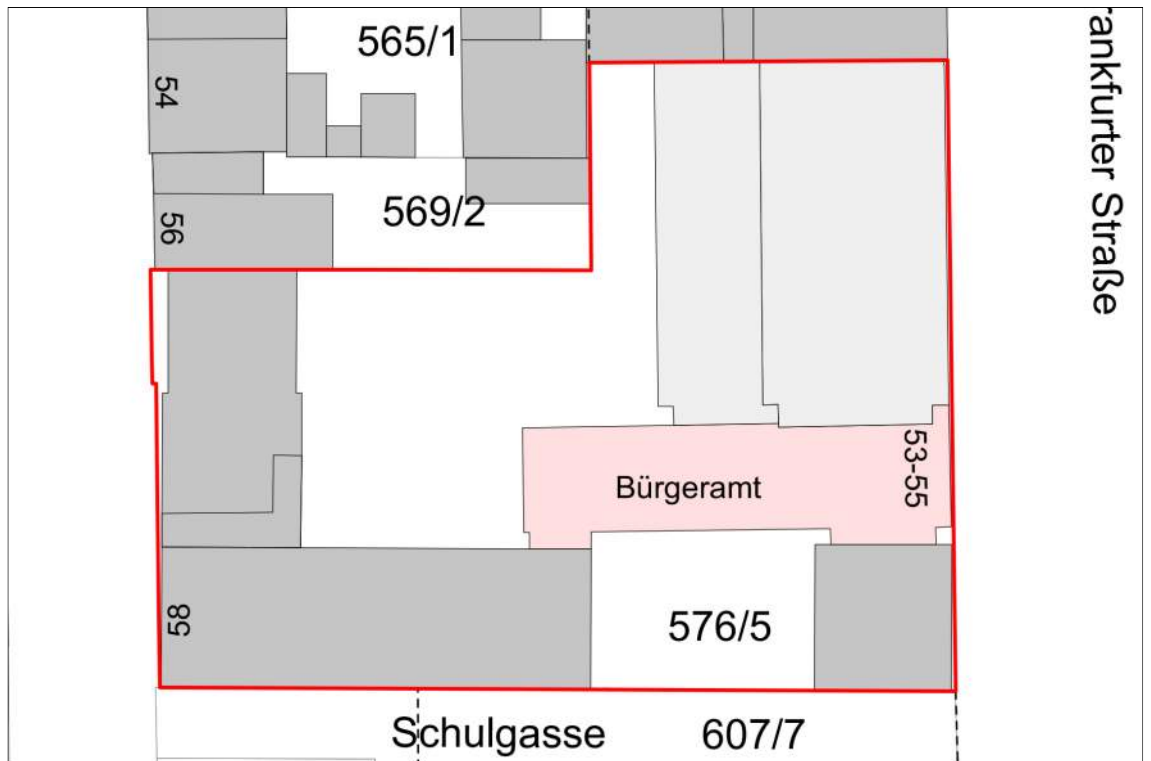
Lageplan, «Maßstab\_Lageplan\_II\_und\_Luftbild» (Eigene Darstellung / Kartengrundlage: Katasterplan Stadt Neu-Isenburg, Stand Mai 2020)
